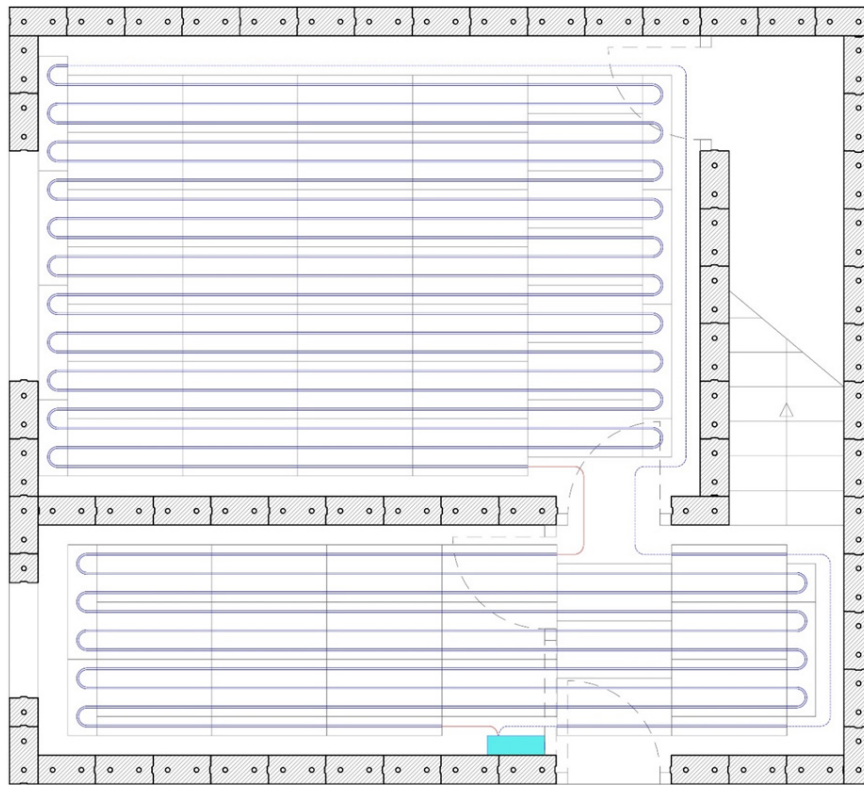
Fußbodenaufbau-Unterkonstruktion/EG
